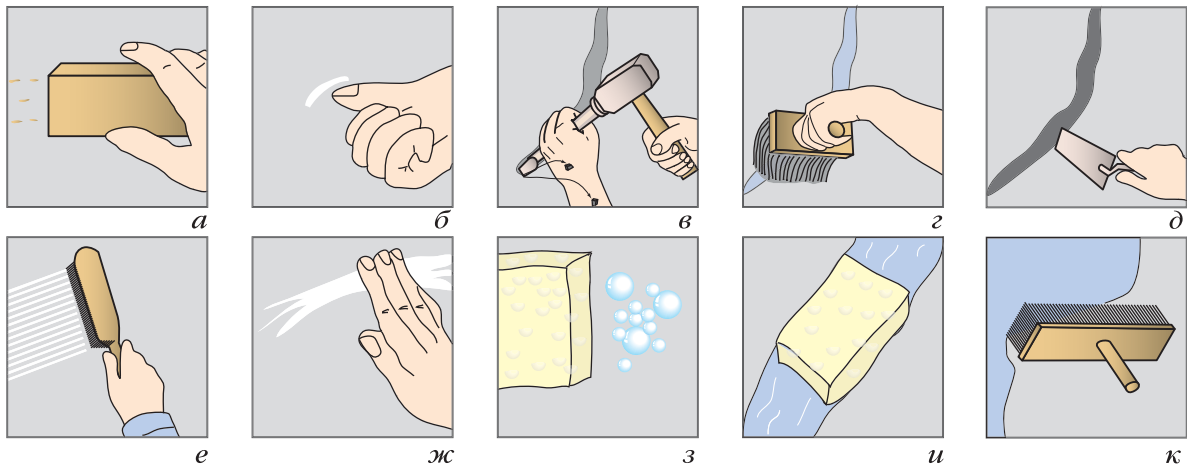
Подготовка основания под покраску: а — проверка прочности деревянным брусом; б — то же, ногтем; в — обнаружение и расшивка трещин; г — грунтование трещин; д — заделка трещин раствором и перетирка штукатурки; е — очистка поверхности щетками; ж — проверка поверхности рукой на мелованность; з — то же, губкой смоченной в уксусе; и — проверка впитывающей способности основания; 5 — грунтовка основания
